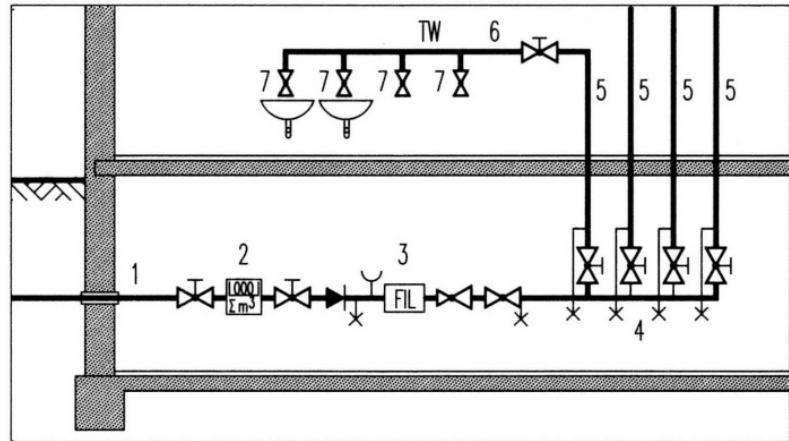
Leitungsschema der Trinkwasser-Leitungsabschnitte⁴⁷²
